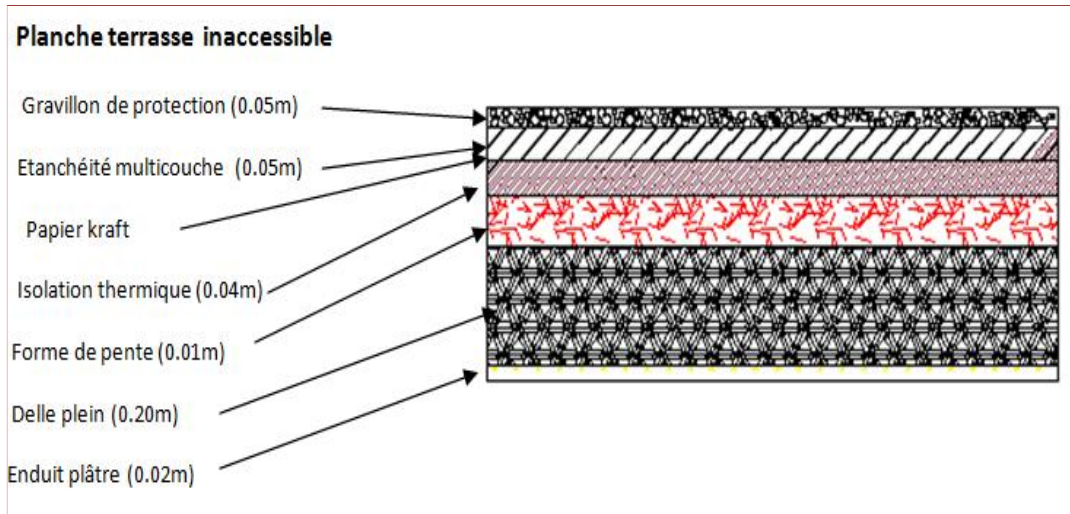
Détail de plancher dalle pleine terrasse inaccessible.
